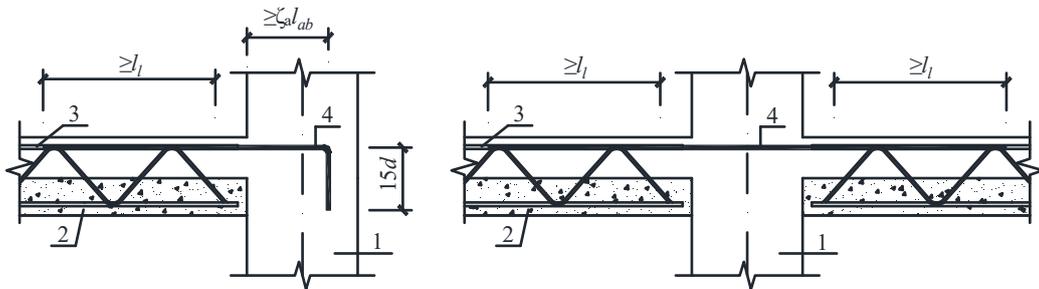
钢筋桁架上弦钢筋搭接构造示意
